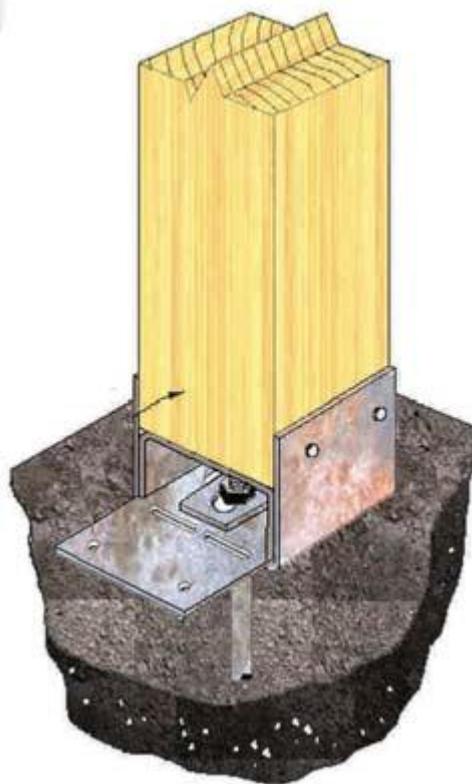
Pieza metálica especial para fijación de pilar de madera, apoyo de hormigón
